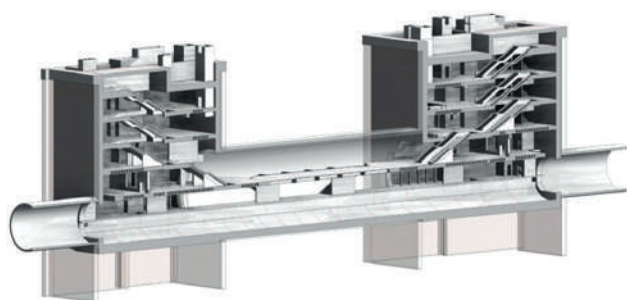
Estação de Hacen Badi – Vista 3D da estrutura definitiva. Hacen Badi Station – 3D view of the definitive structure.
